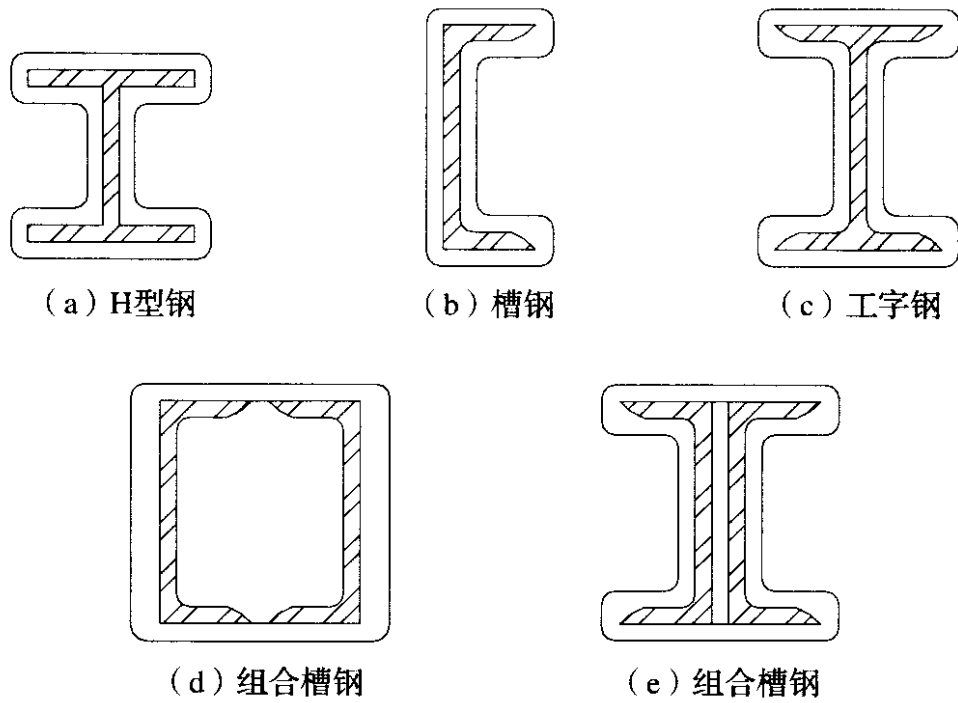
钢梁顶无覆盖层防火保护形式示意
